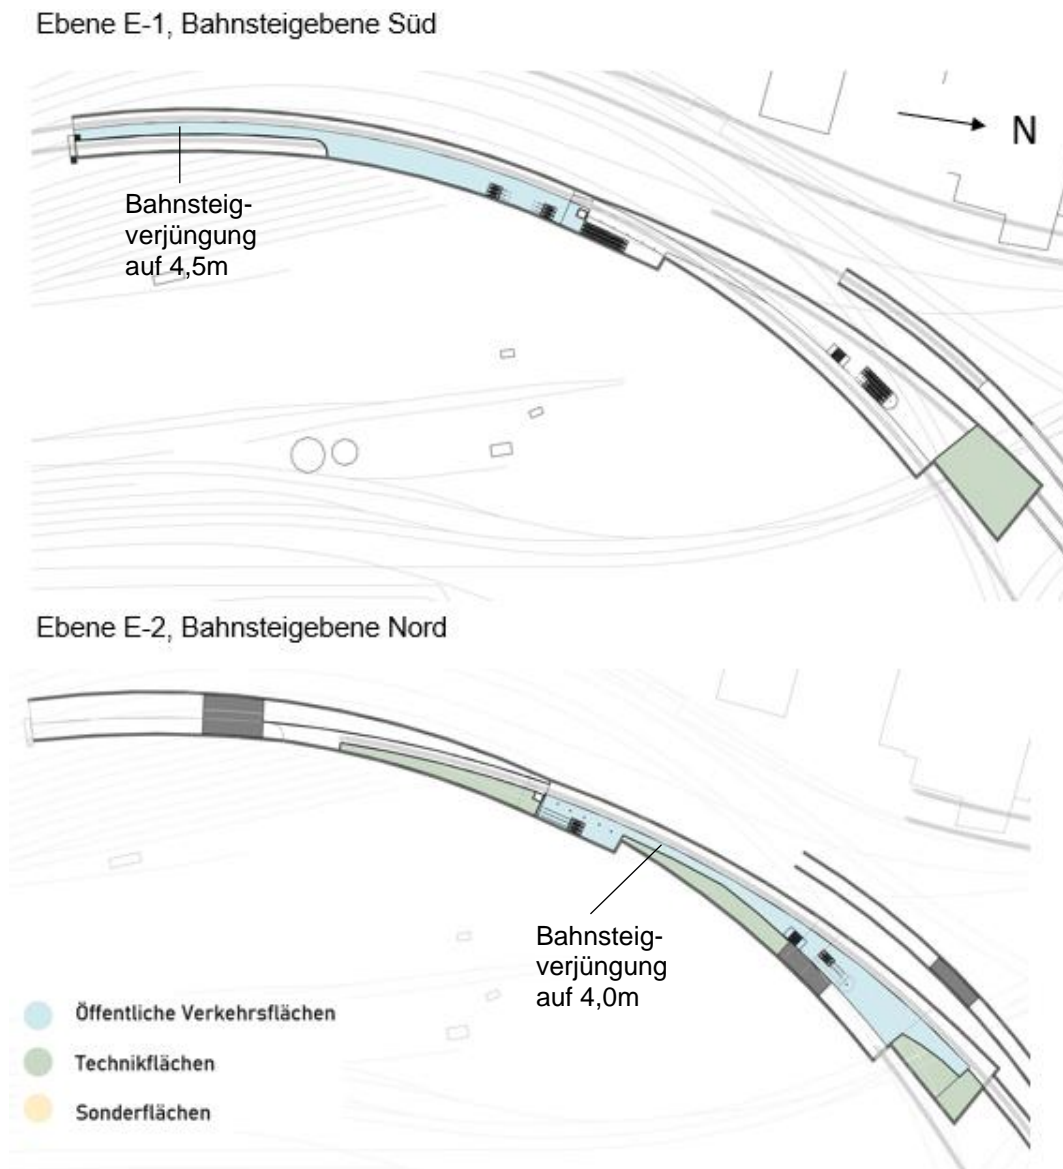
Hp Altona Mitte – Grundrisse
